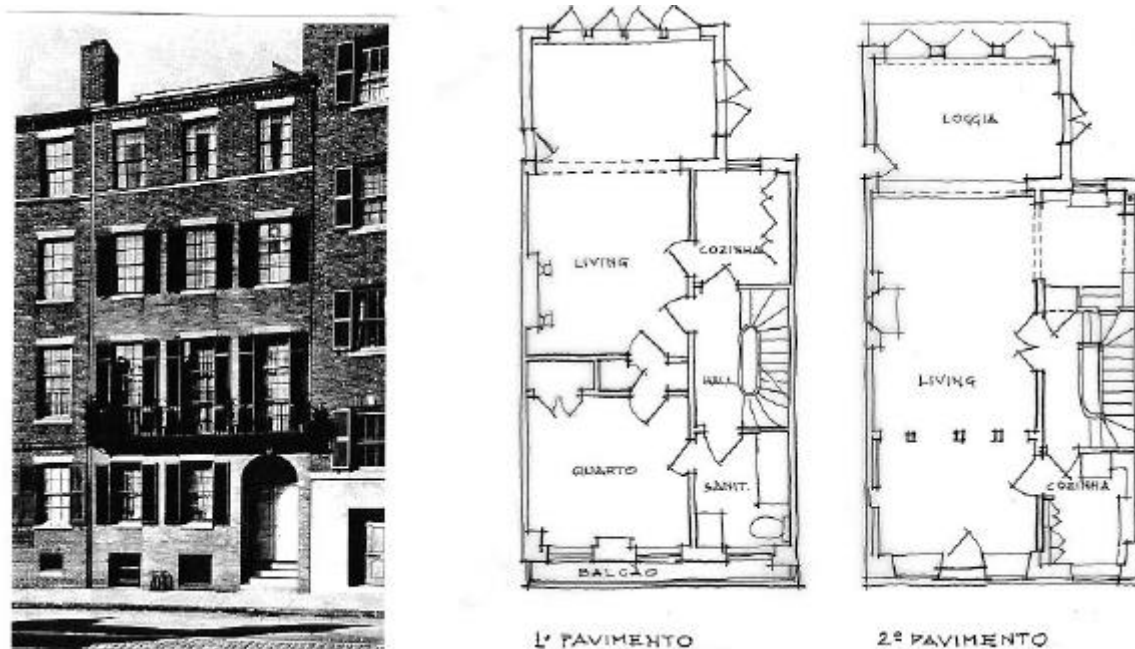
Fachada e plantas de dois dos pavimentos da casa de Eleonor Raymond (1924).
